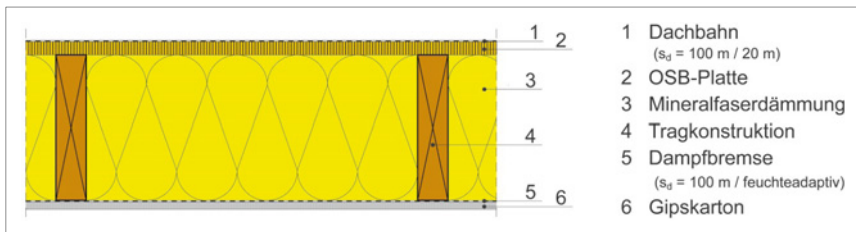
Aufbau des betrachteten Flachdachs in Holzbauweise
